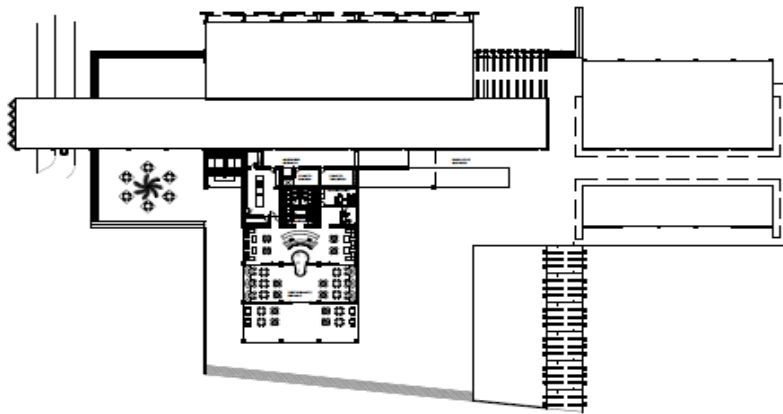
Segmentación por Volúmenes. Nave 3, Planta Baja. (2017)
